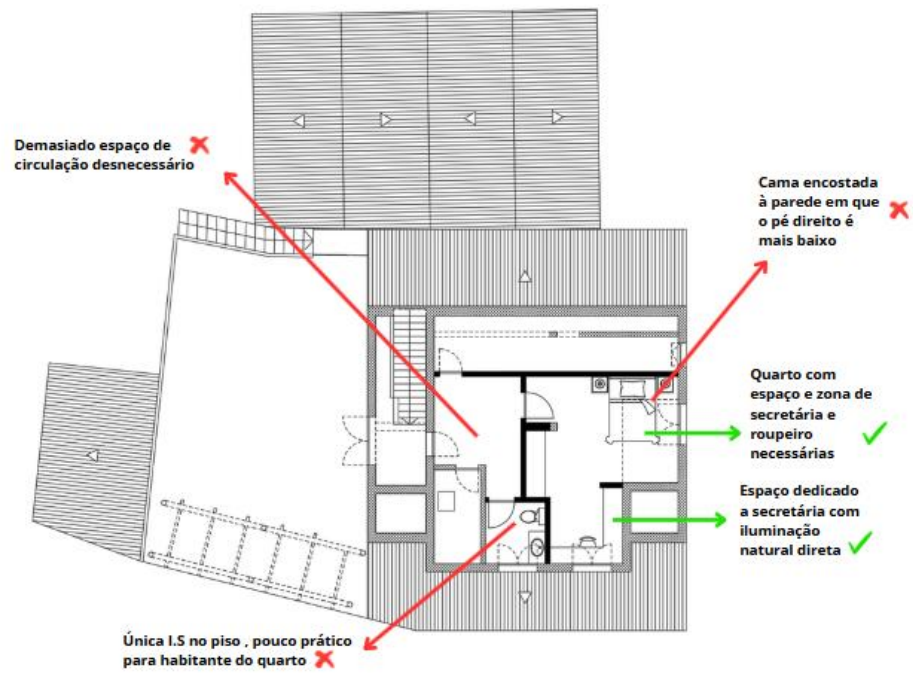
Análise de plantas esboço, proposta 4, piso 1
